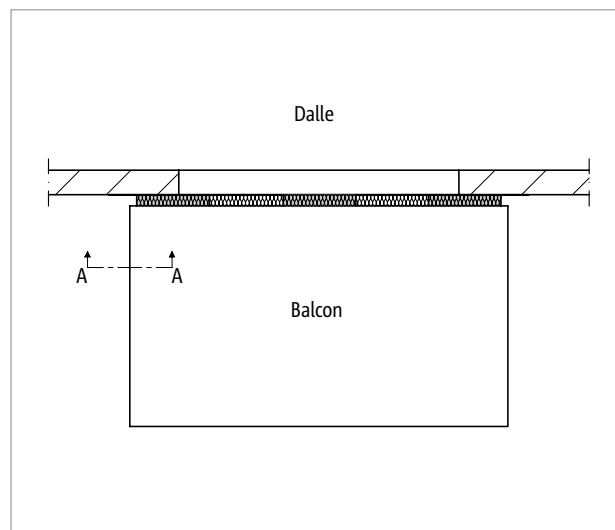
Schöck Isokorb® T Type K-E, K-T : Coupe A-A
